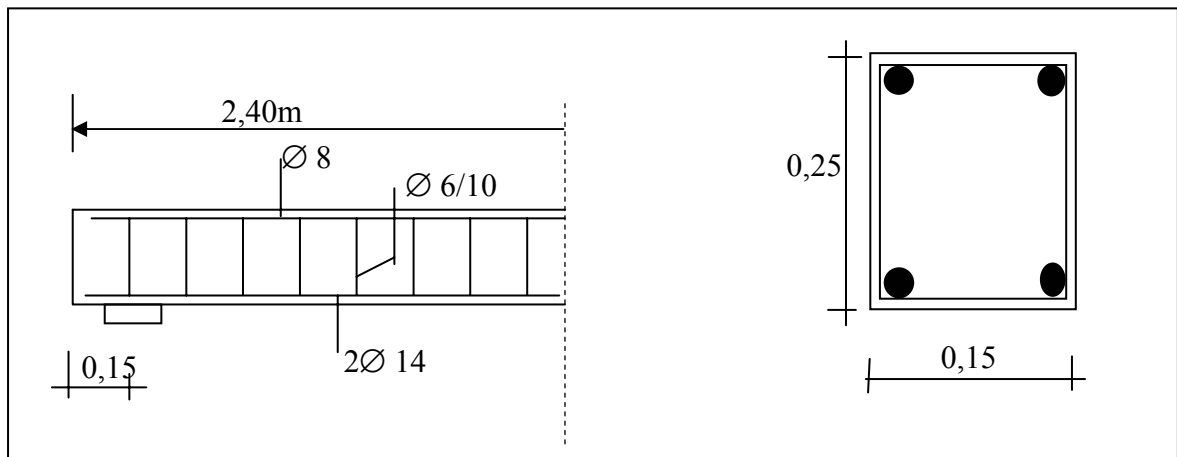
Querschnitt und Bewehrung [12, 13]
